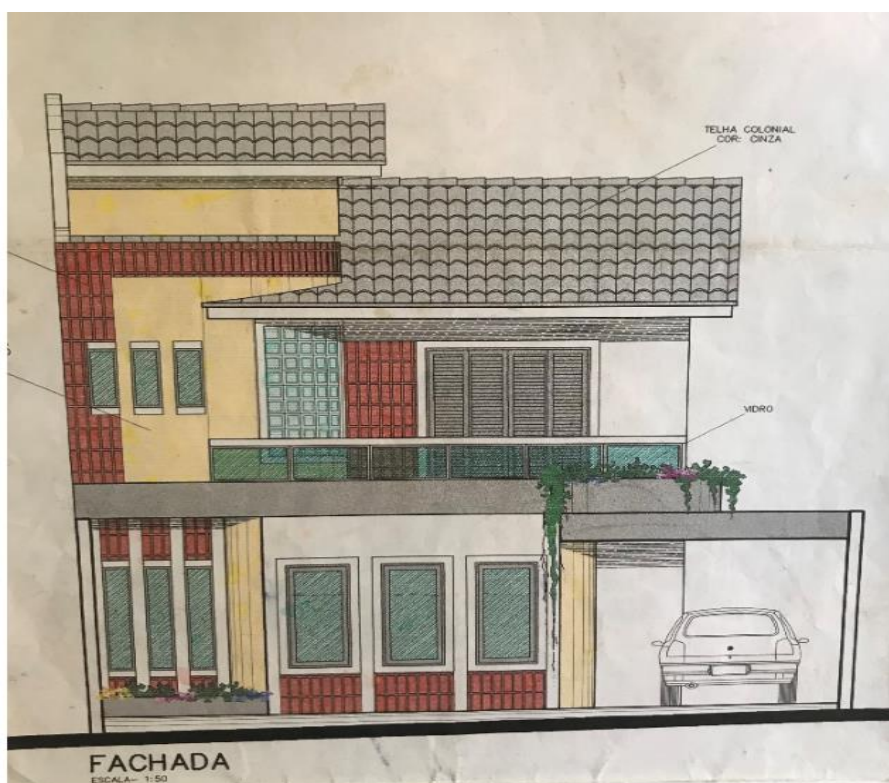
Detalhe da Fachada do imóvel paradigma.
